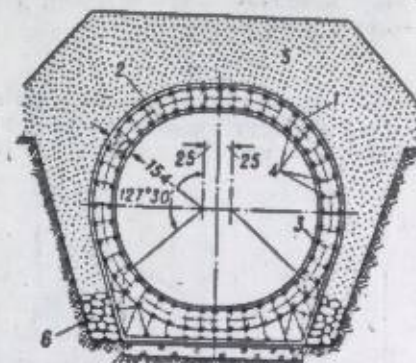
Железобетонный трубопровод: 1 — наружная кольцевая арматура; 2 — внутренняя кольцевая арматура; 3 — распределительная арматура; 4 — хомуты; 5 — насыпной грунт; 6 — дренаж.
